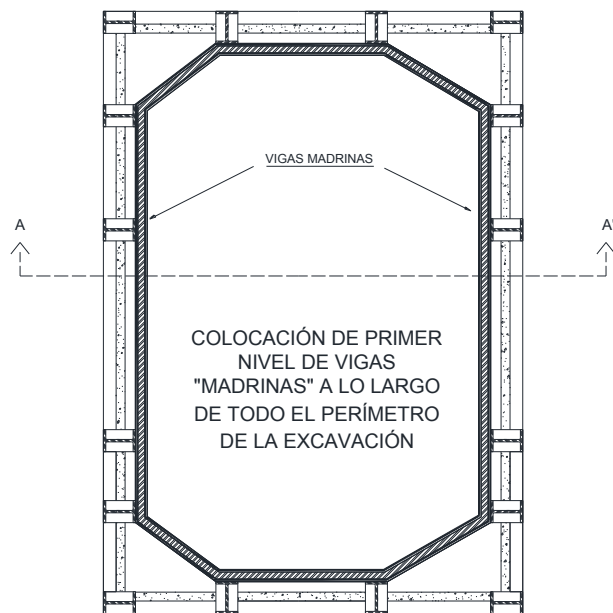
Primer nivel de apuntalamiento del muro Berlín
